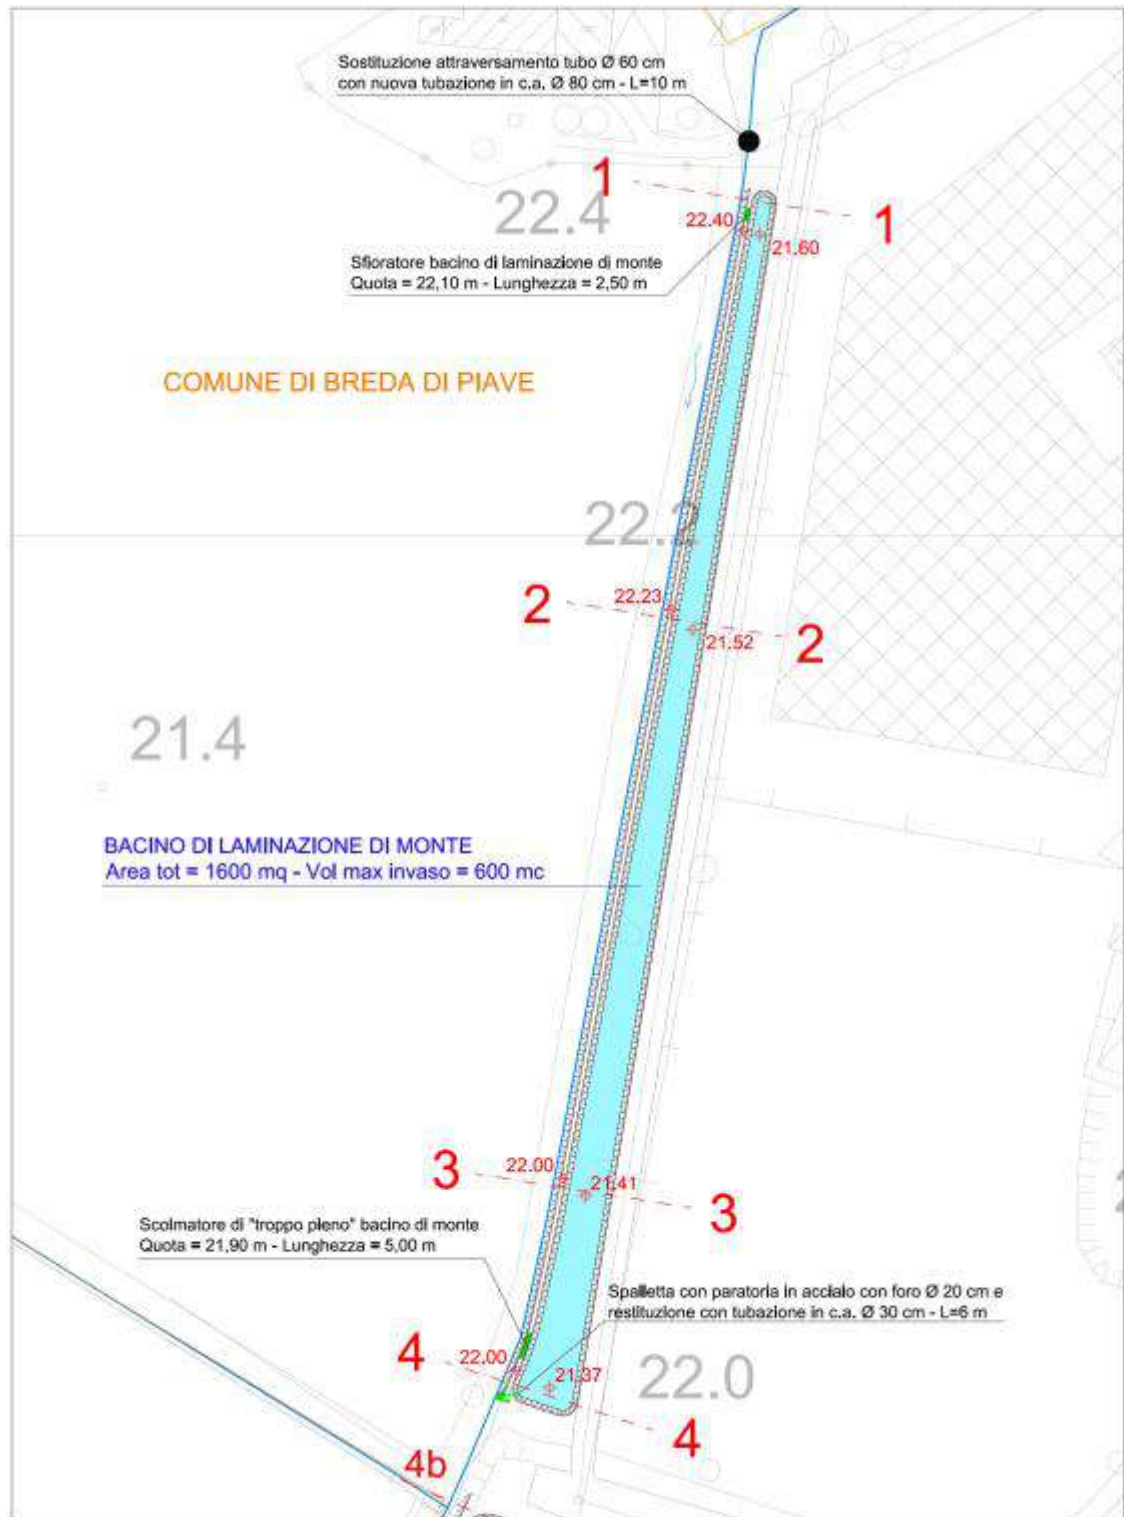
Planimetria del Bacino di laminazione di monte
